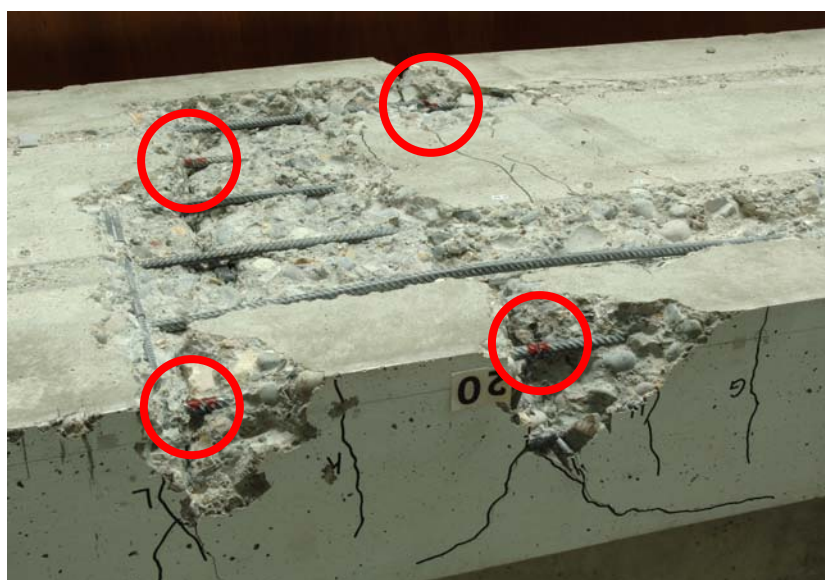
Barras da armadura interna rompidas por fadiga.
